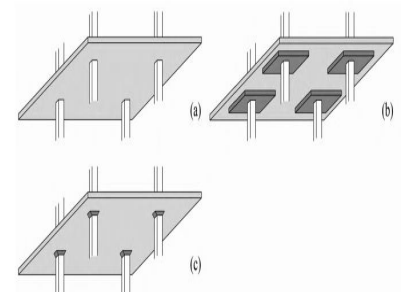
(a) sans chapiteaux (b) avec chapiteaux (c) avec goussets Systèmes de plaque plate / dalle
